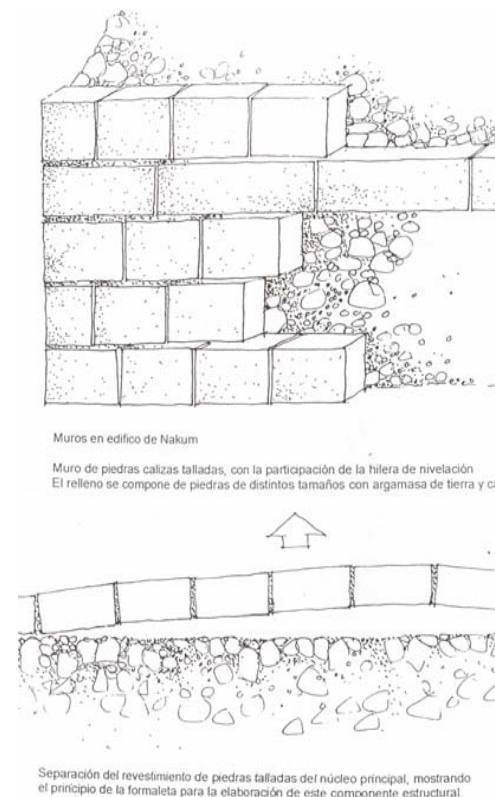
Detalle del muro fachaleta y su núcleo central Nakum. (PRONAT)
